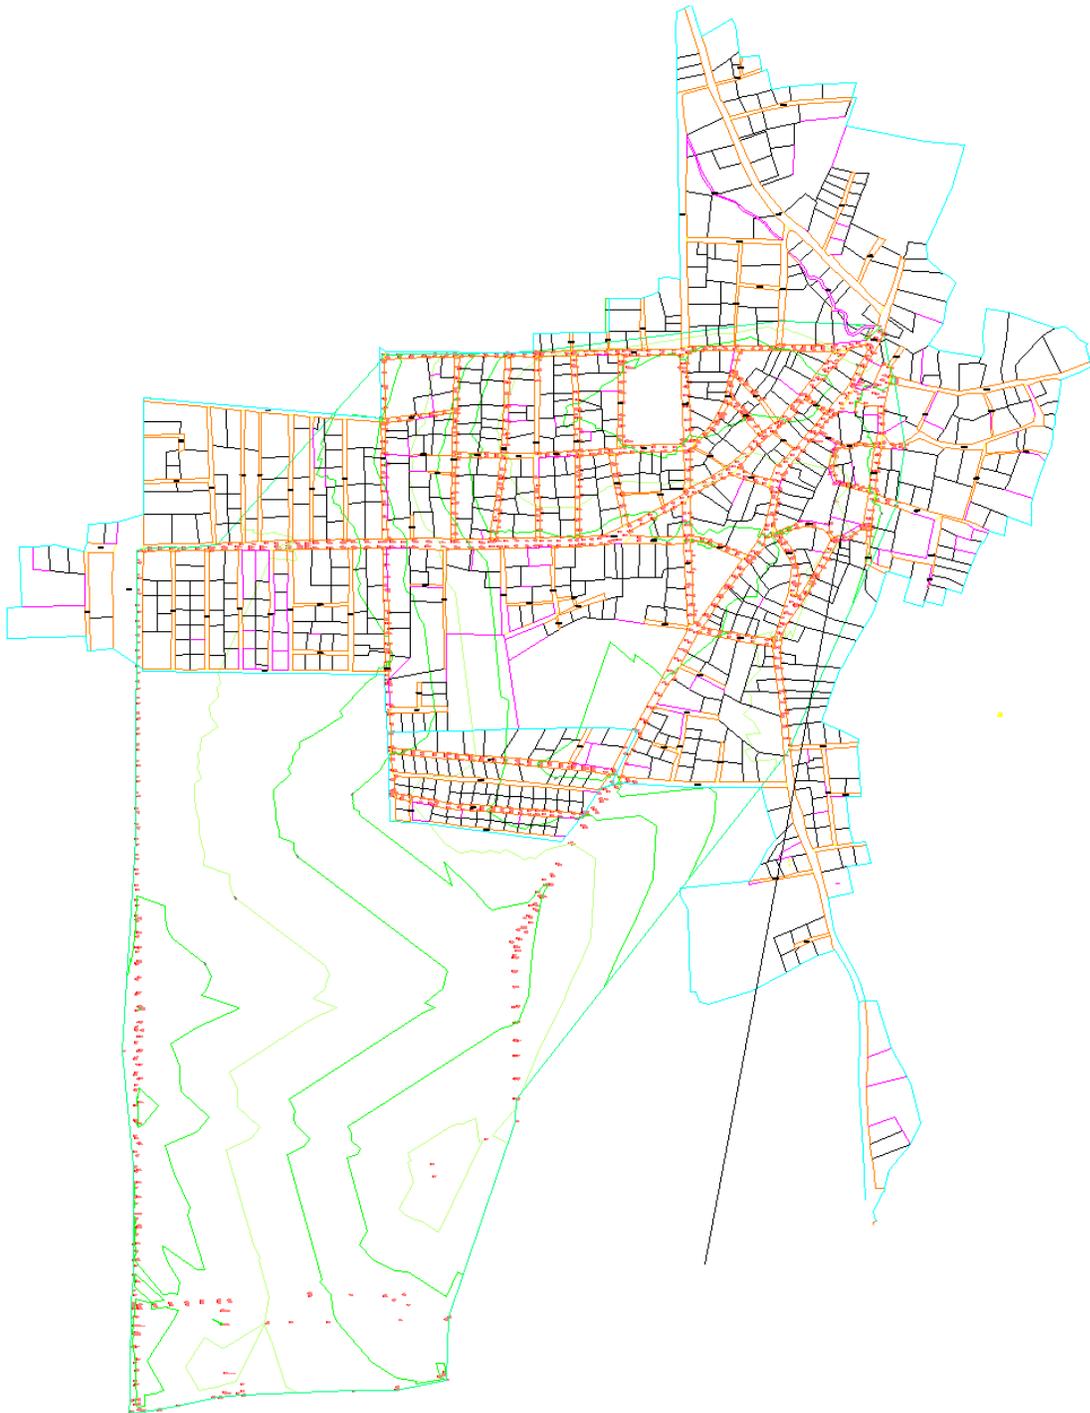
Alineación del levantamiento topográfico con los puntos de elevación.
